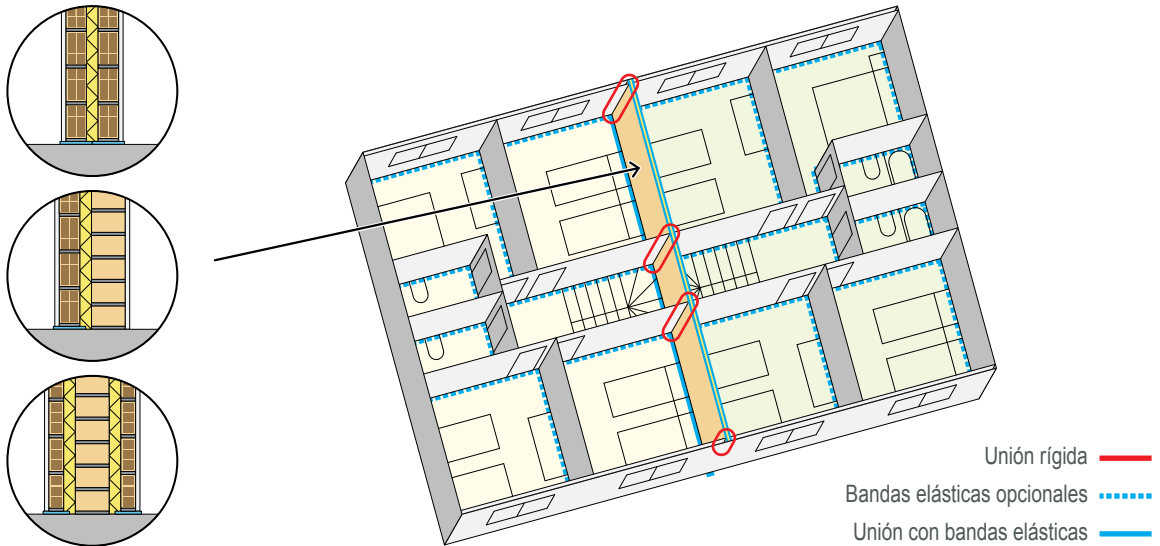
CASO 2: separadora entre viviendas de DOS o TRES hojas y edificio SIN exigencia de aislamiento acústico en vertical. Colocación de bandas elásticas en los tabiques y hojas interiores de fachada.
